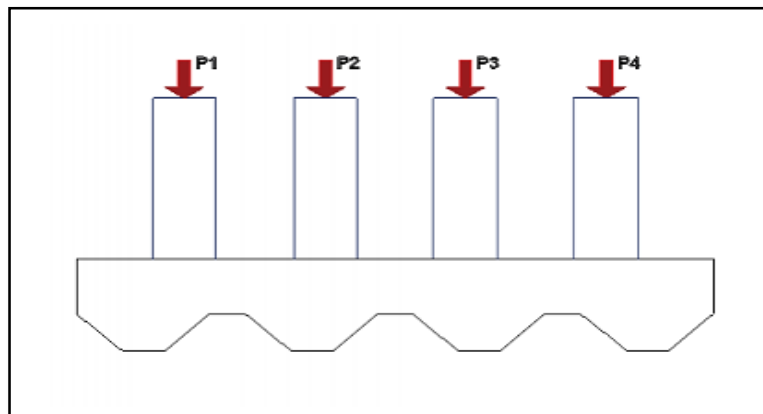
Losa de Cimentación compuesta de una losa maciza con espesor uniforme.
